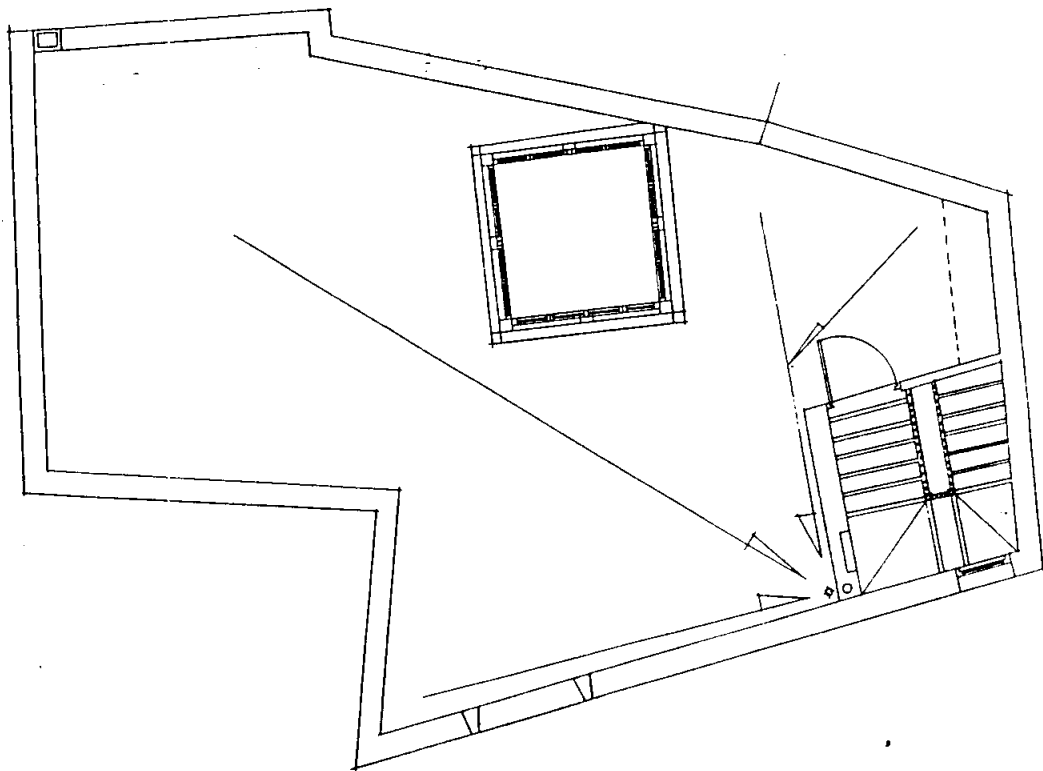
DETAIL : Porte d'entrée donnant accès au 1^{er} étage
